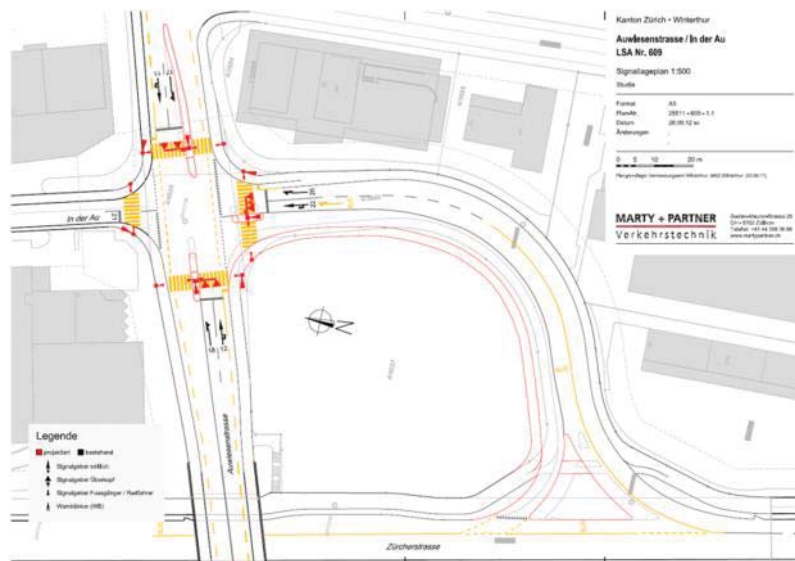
Signallageplan LSA Nr. 609 (vgl. Anhang A4)
